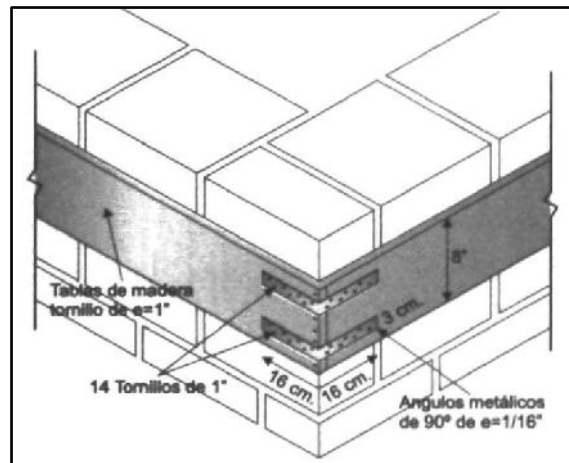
Detalle A: Unión metálica exterior (Kuroiwa, 2002)
